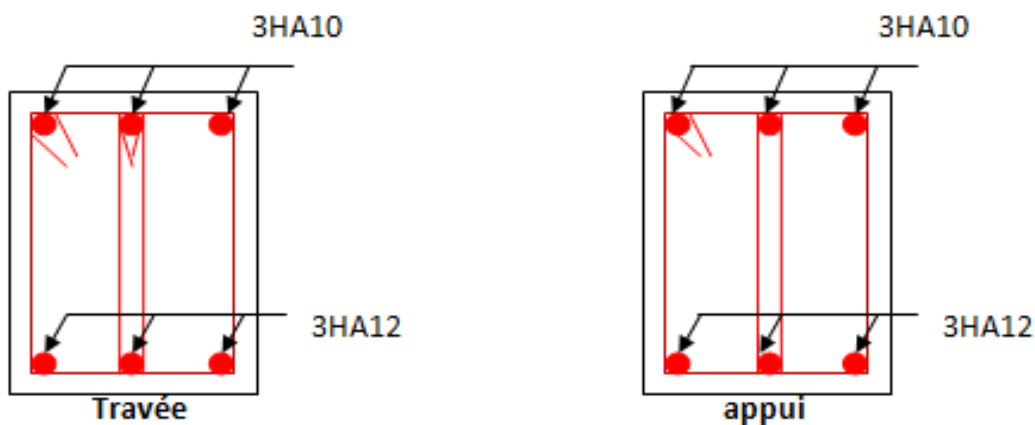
Schéma de ferrailage de la poutre de chaînage.
